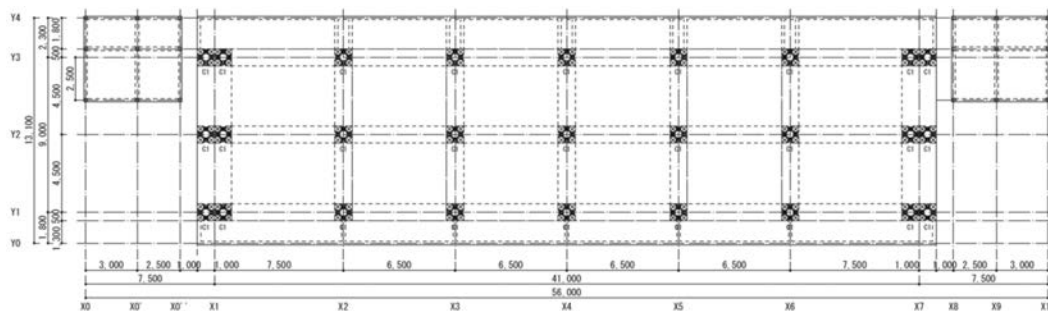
木質接着パネル・集成材複合構造の10階建て集合住宅の基準階の平面図
